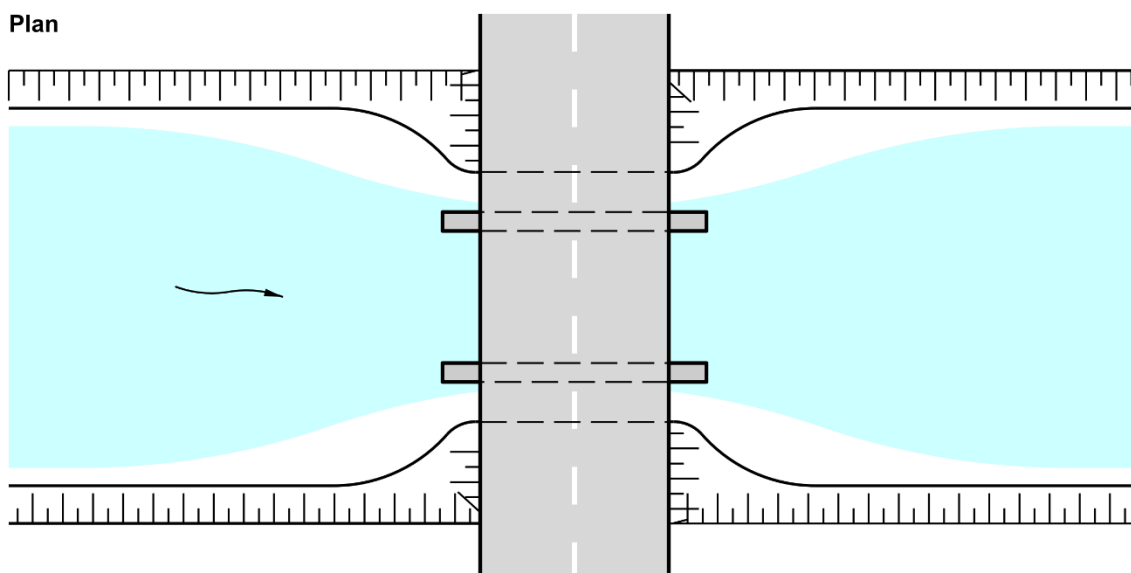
Exemple d'un important rétrécissement induit par la construction d'un pont
